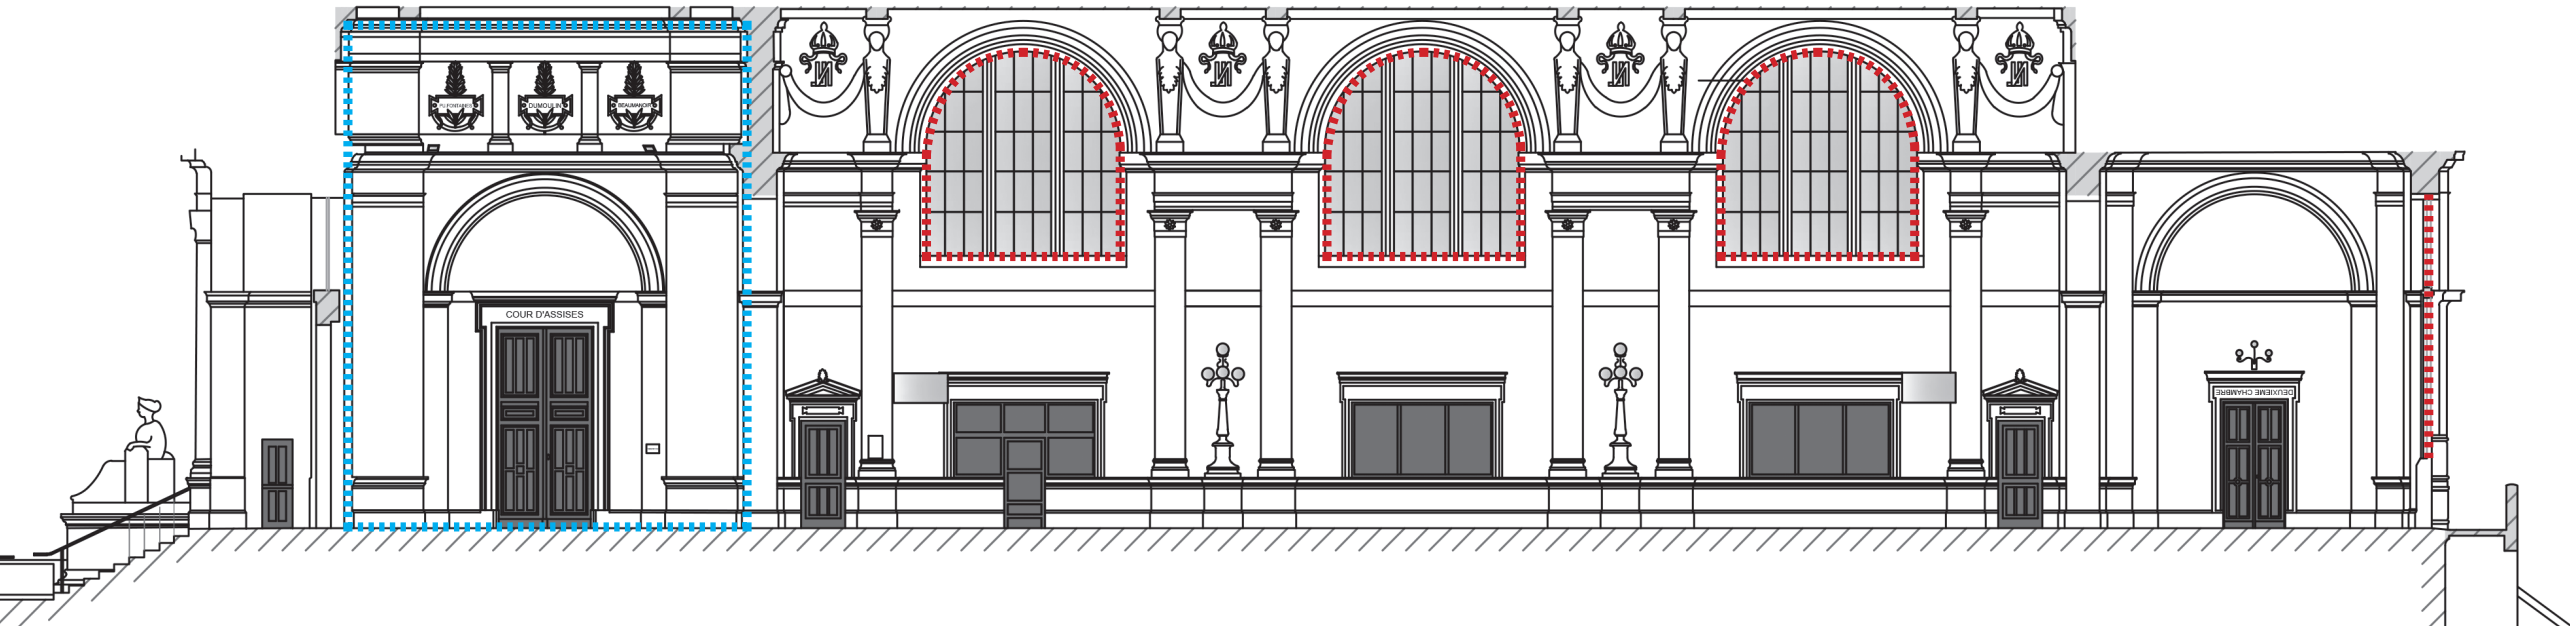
Coupe longitudinale sur la salle des pas perdus.
